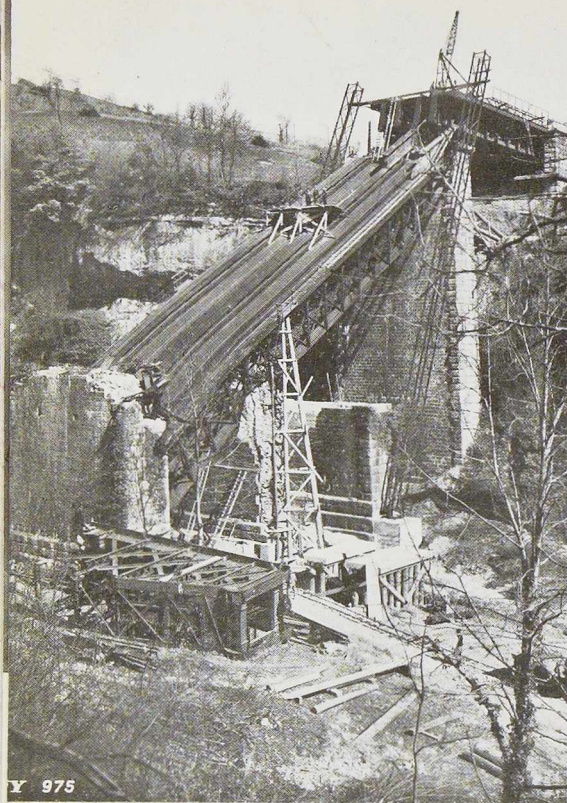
Préparation du chantier. Montage des deux pylônes légers dont l'un, d'une hauteur de 40 mètres, s'appuie sur une fondation en béton et l'autre, d'une hauteur de 32 mètres, sur la pile centrale. Les rapports d'élançement des pylônes constitués chacun par 4 fers HN12 et H14 valent respectivement 80 et 64.
